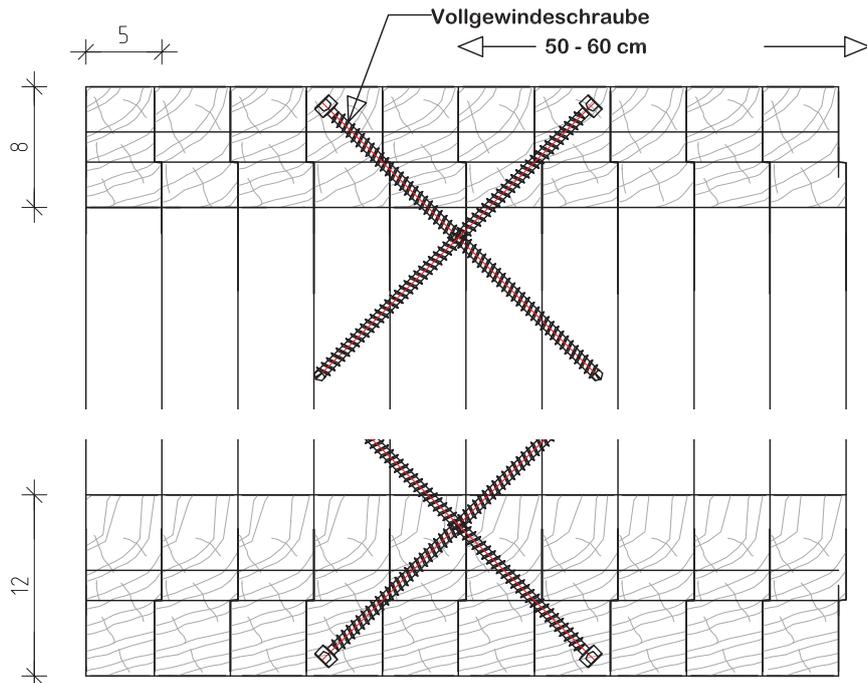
, Detail Brettstapelelemente Decke (o.) und Boden (u.) M 1 : 5
